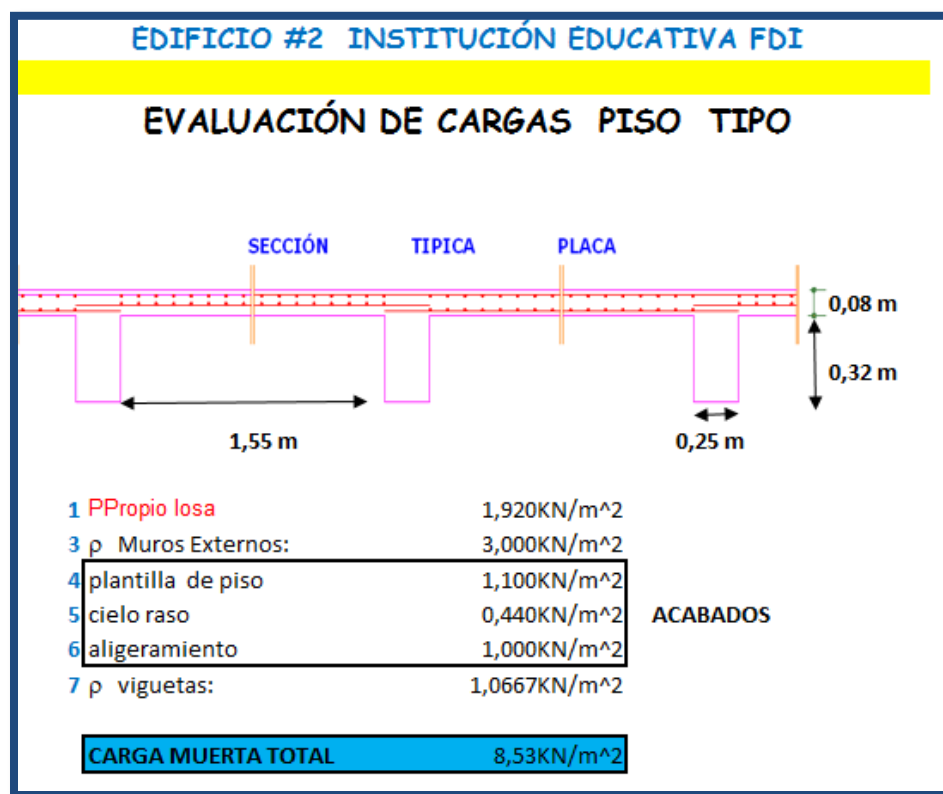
Evaluación de cargas edificio #2. Fuente: Levantamiento estructural
